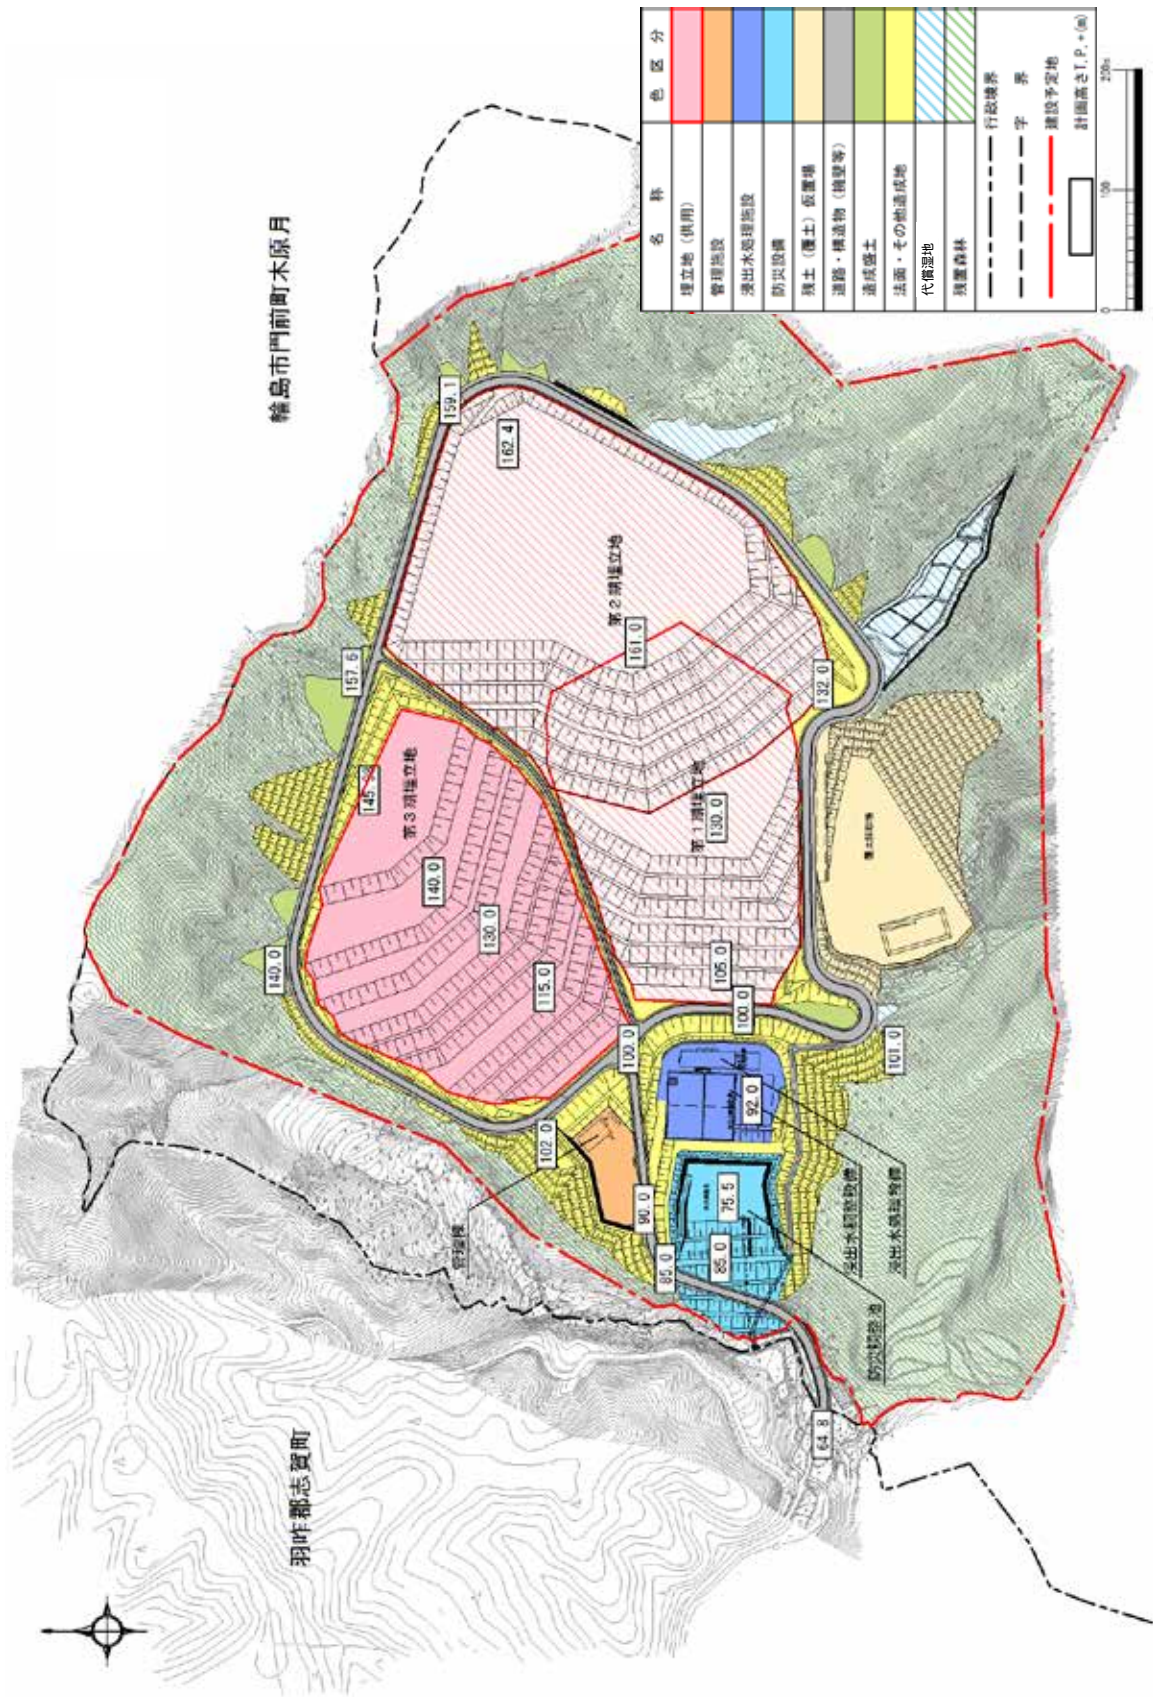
造成・施設配置計画平面図（第3期埋立完了後）
